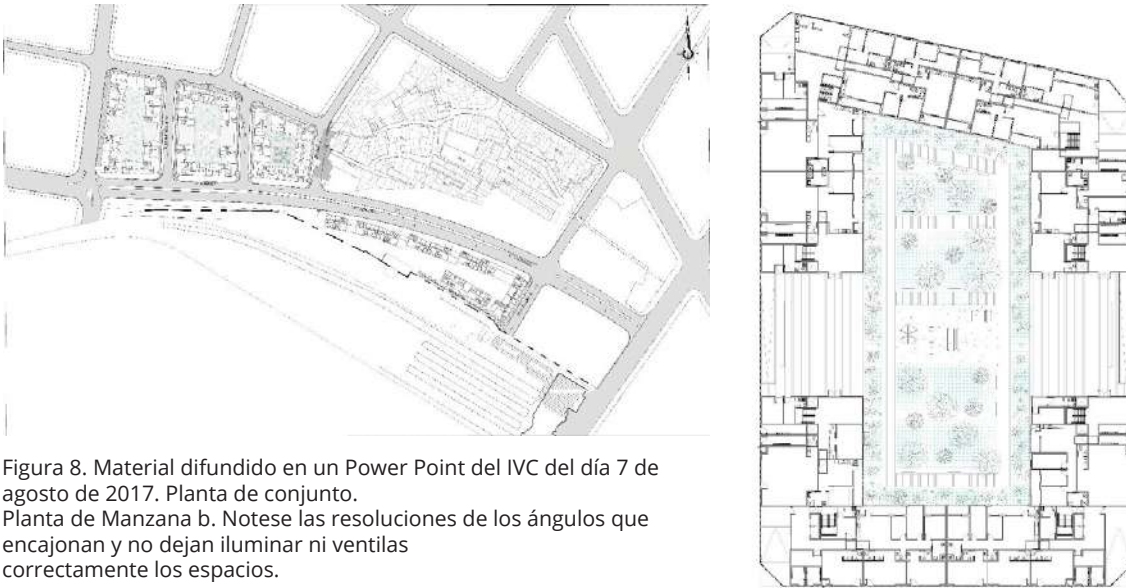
Material difundido en un Power Point del IVC del día 7 de agosto de 2017. Planta de conjunto. Planta de Manzana b. Note se las resoluciones de los ángulos que encajonan y no dejan iluminar ni ventilan correctamente los espacios.
